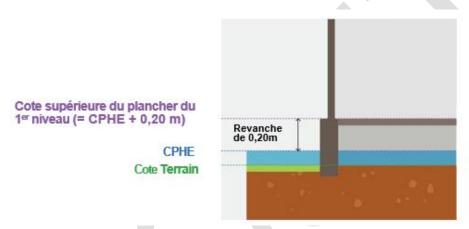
Illustration de l'implantation d'un bâtiment en zone de débordement de cours d'eau (Mayane, 2018)
